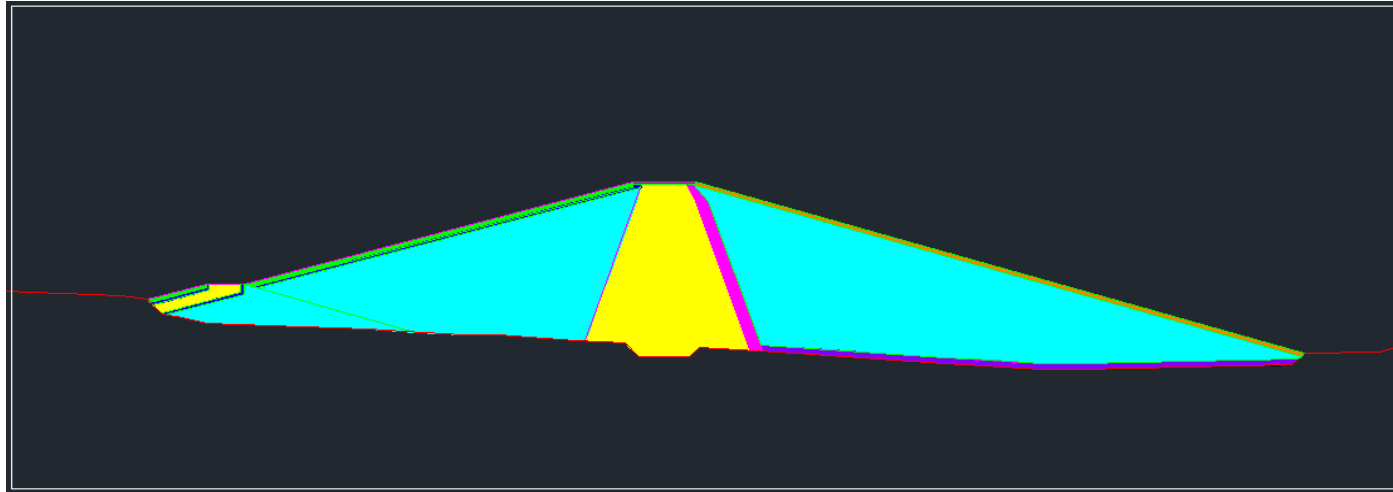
Metraj alan hesaplama – Kesit 1
